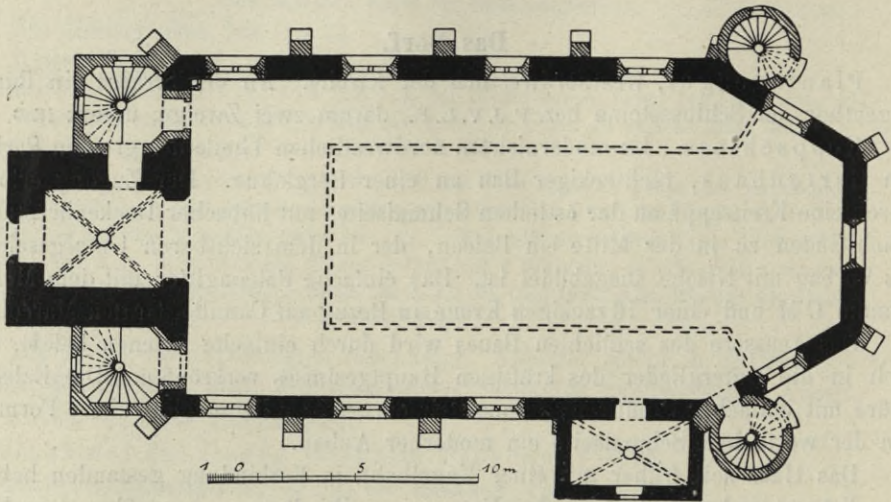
Kaditz, Grundriss der Kirche.
